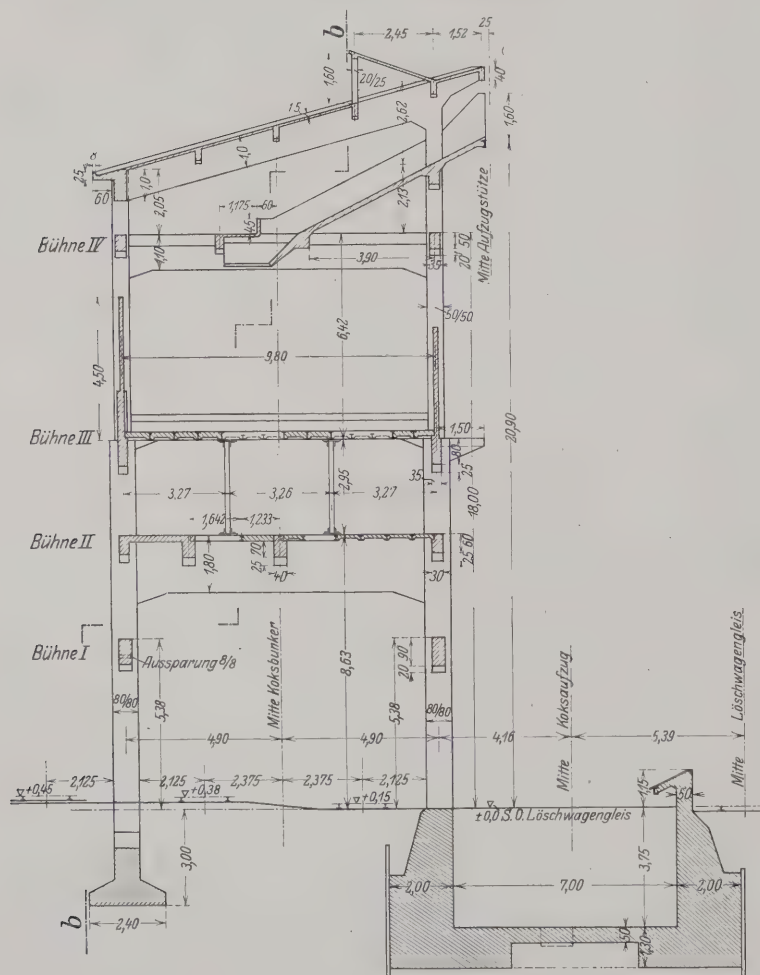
Querschnitt a-a mit Aufzugsgrube.
